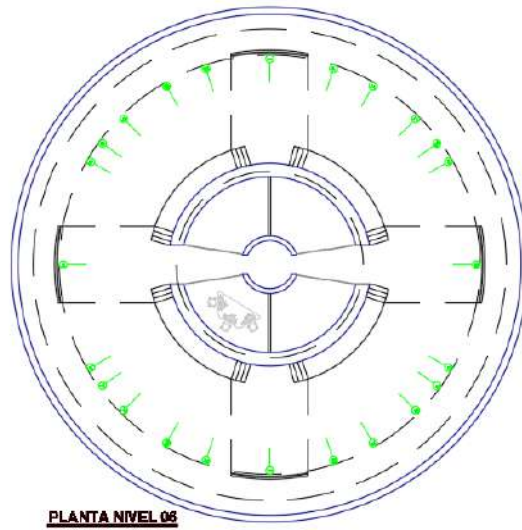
Planta del sexto nivel. (Fuente Autor)
